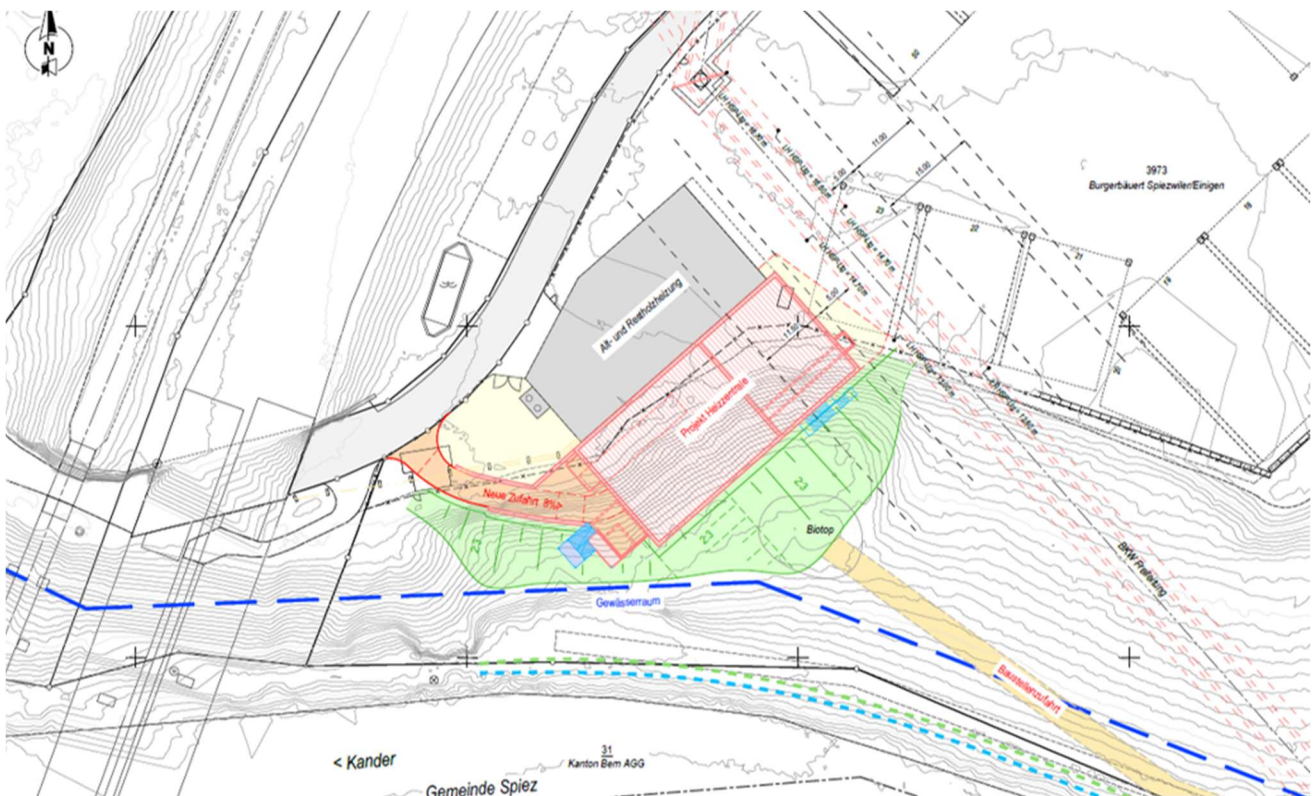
Überblick Erweiterung ARHH mit neuer Zufahrt
